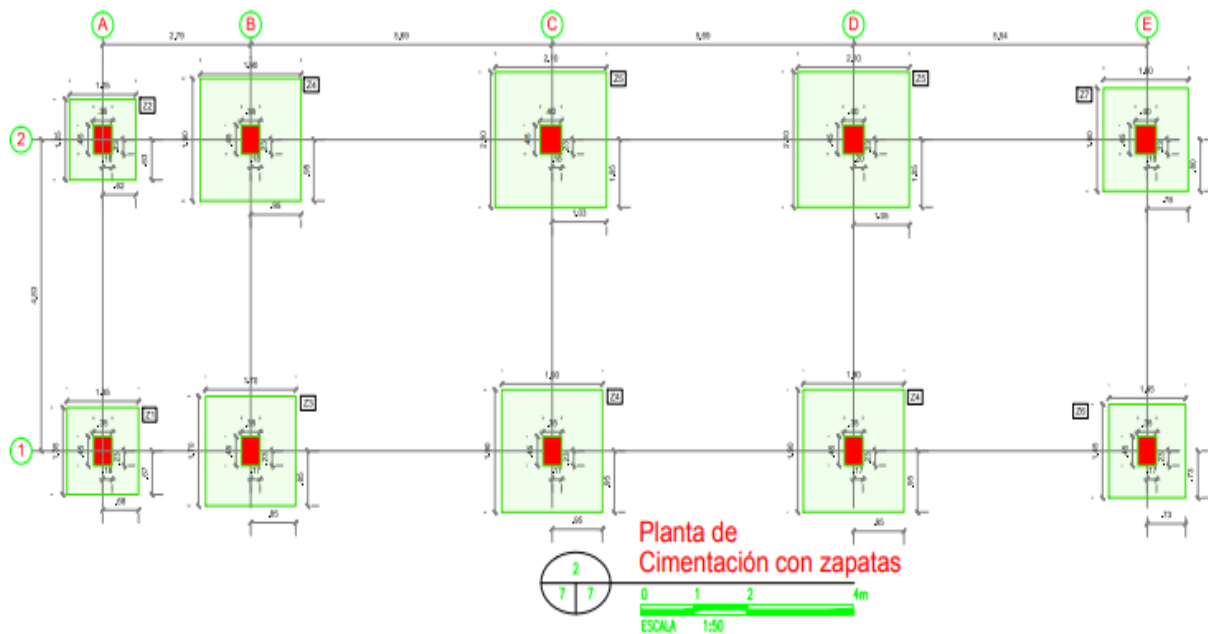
Distribución Inicial de Zapatas en Planta.
